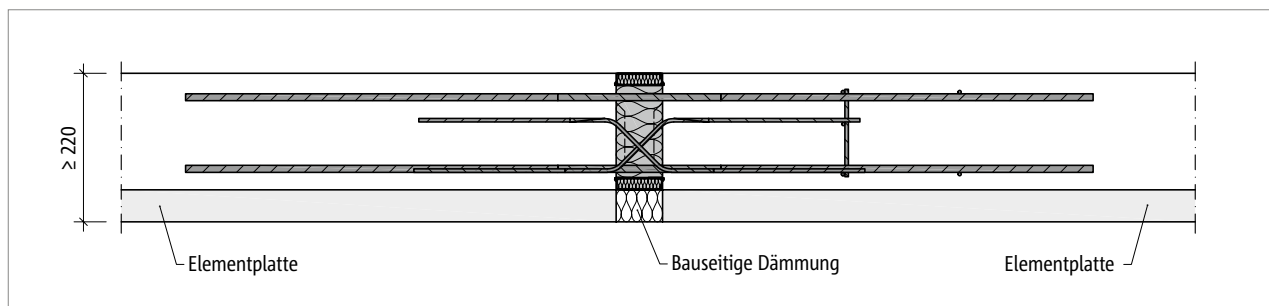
Schöck Isokorb® T Typ DP: Elementdecke mit aufgesetztem Isokorb® T Typ DP
